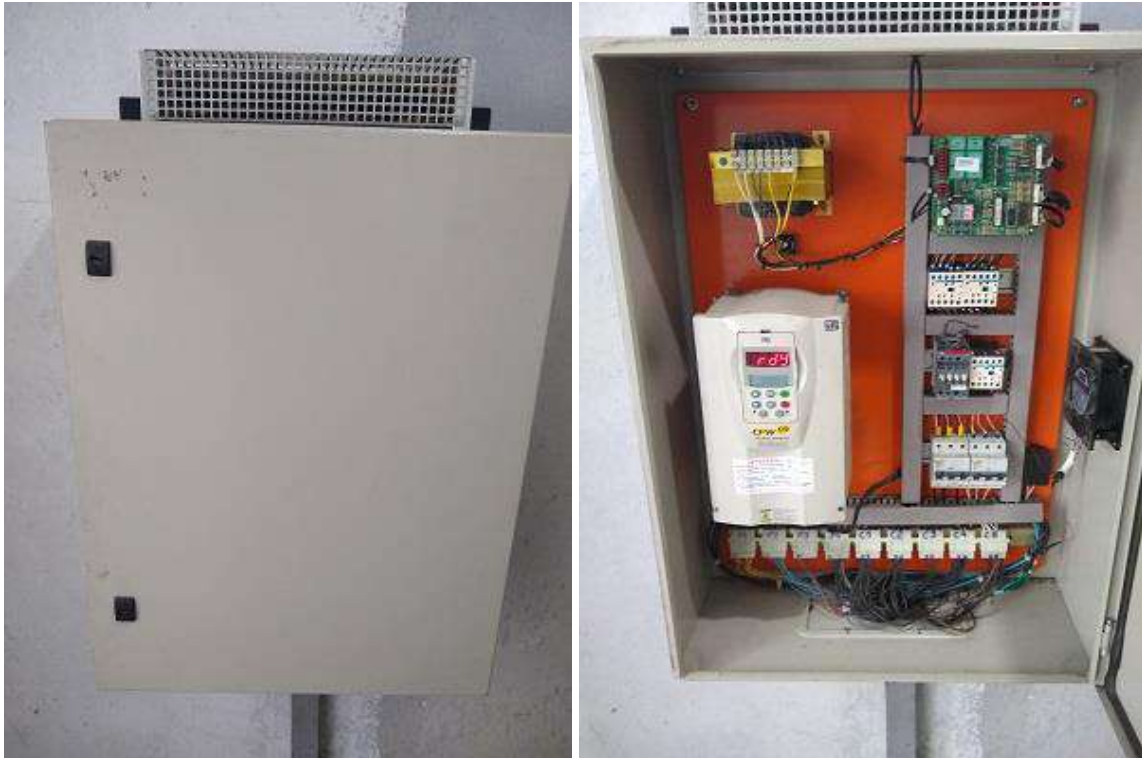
Quadro de comando dos elevadores “QD-Elevador” – Pavimento cobertura.
